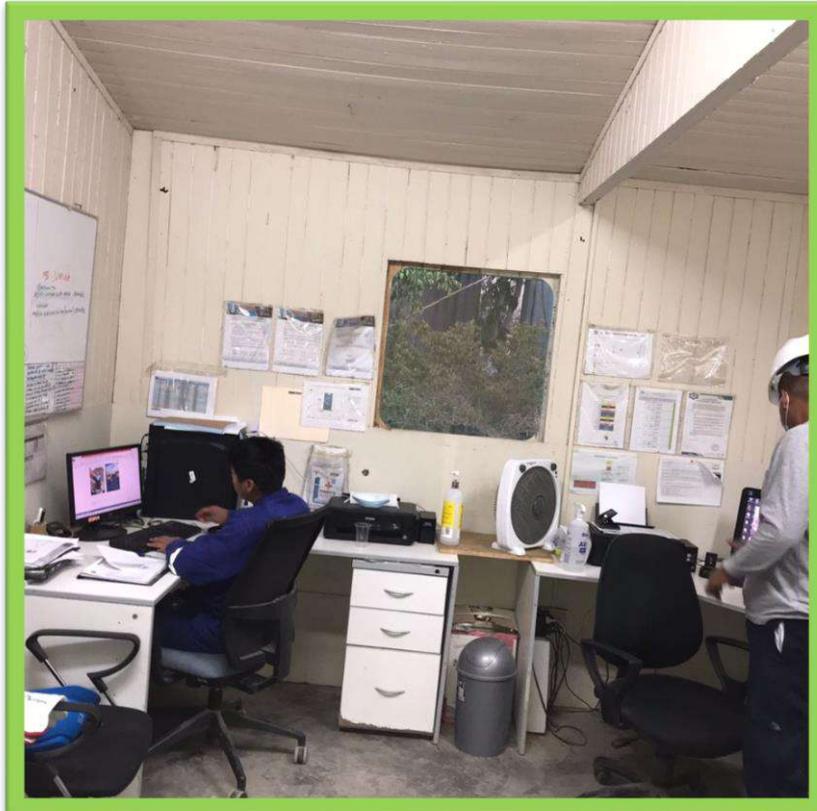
Muros y cielo raso de paneles machiembreado prefabricado
